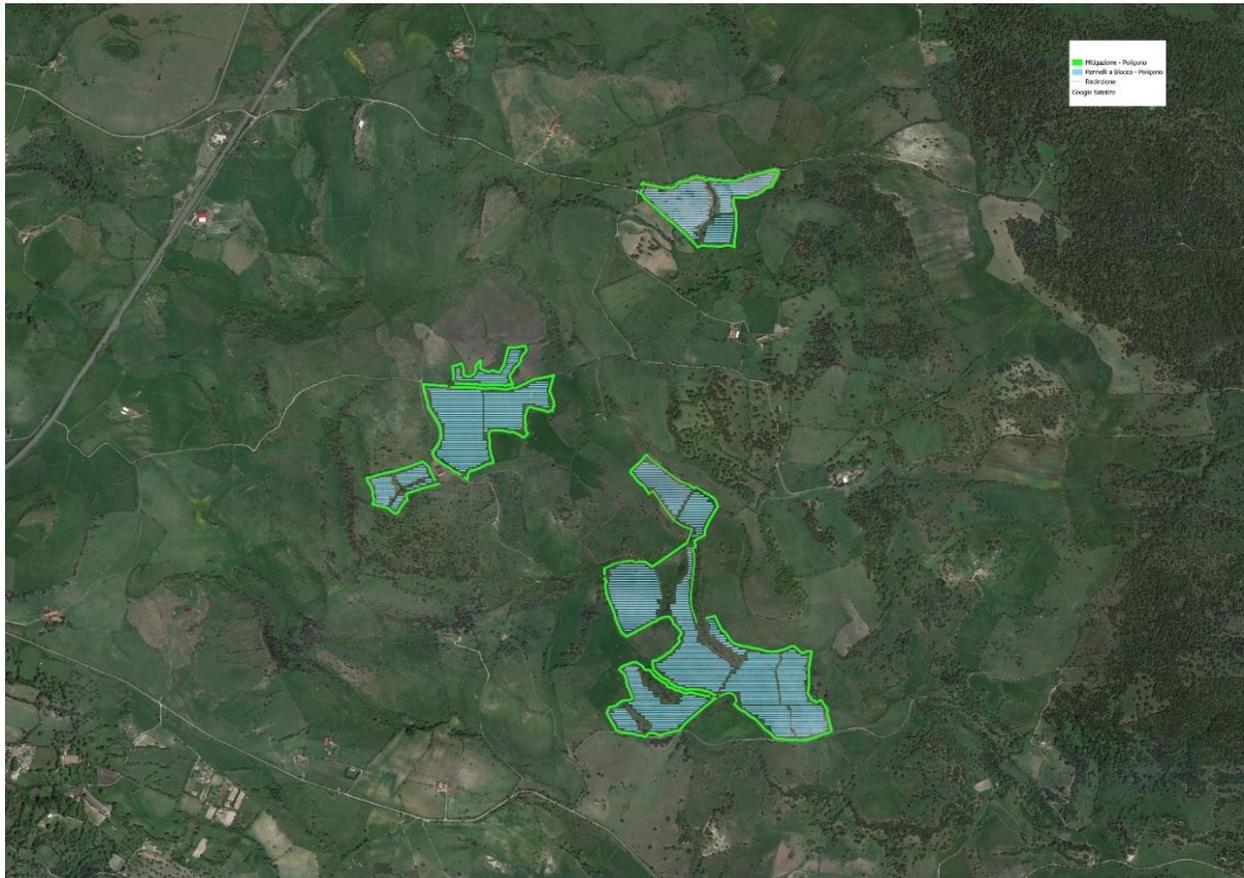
Stralcio planimetrico – Layout e misure di mitigazione
